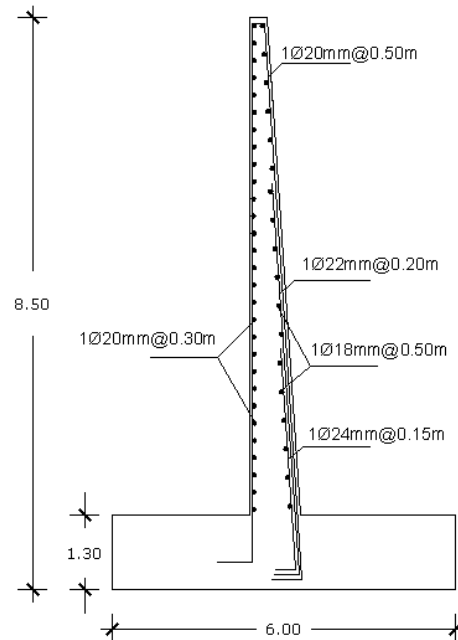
61 Armado de la Pantalla del Muro de Ala
